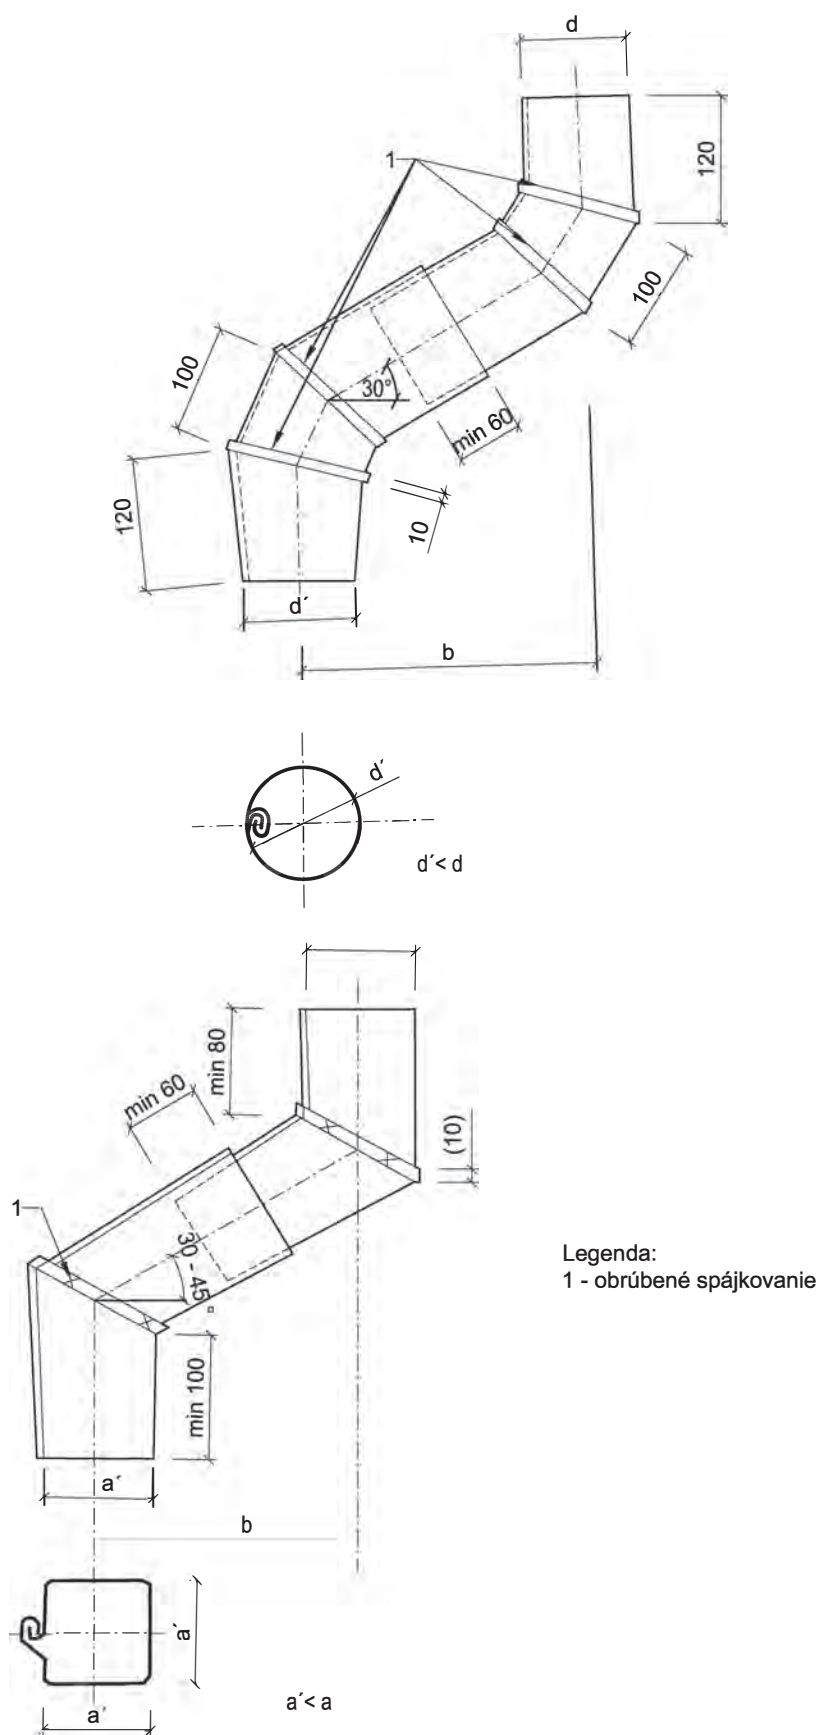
Detail vyhotovenia prechodu dažďového zvodu cez konštrukciu rímsy
